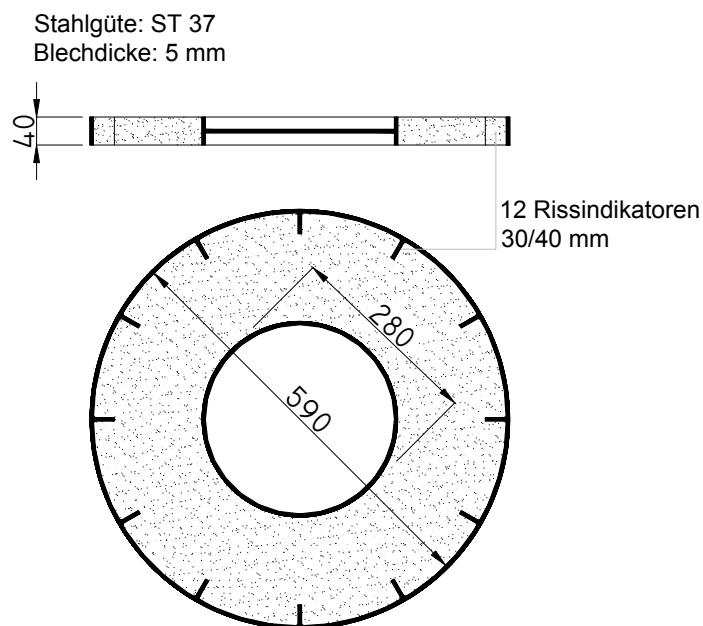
Kleinprüfkörper zur Bestimmung der Faserbetonklassen
